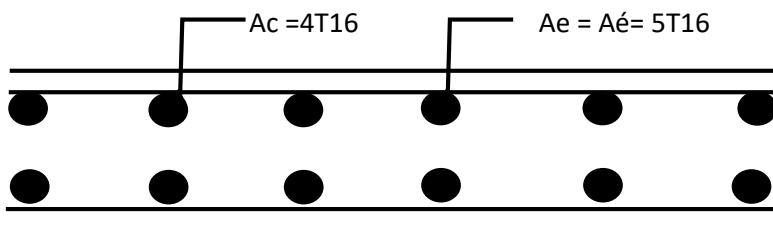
Dispositions du ferrailage longitudinal du voile
